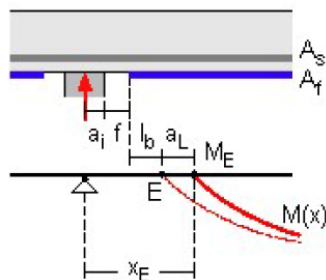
Esquema de posicionamento de laminados aderidos externamente (A_f), corte longitudinal – Vão 49-37 - Pórtico 11
